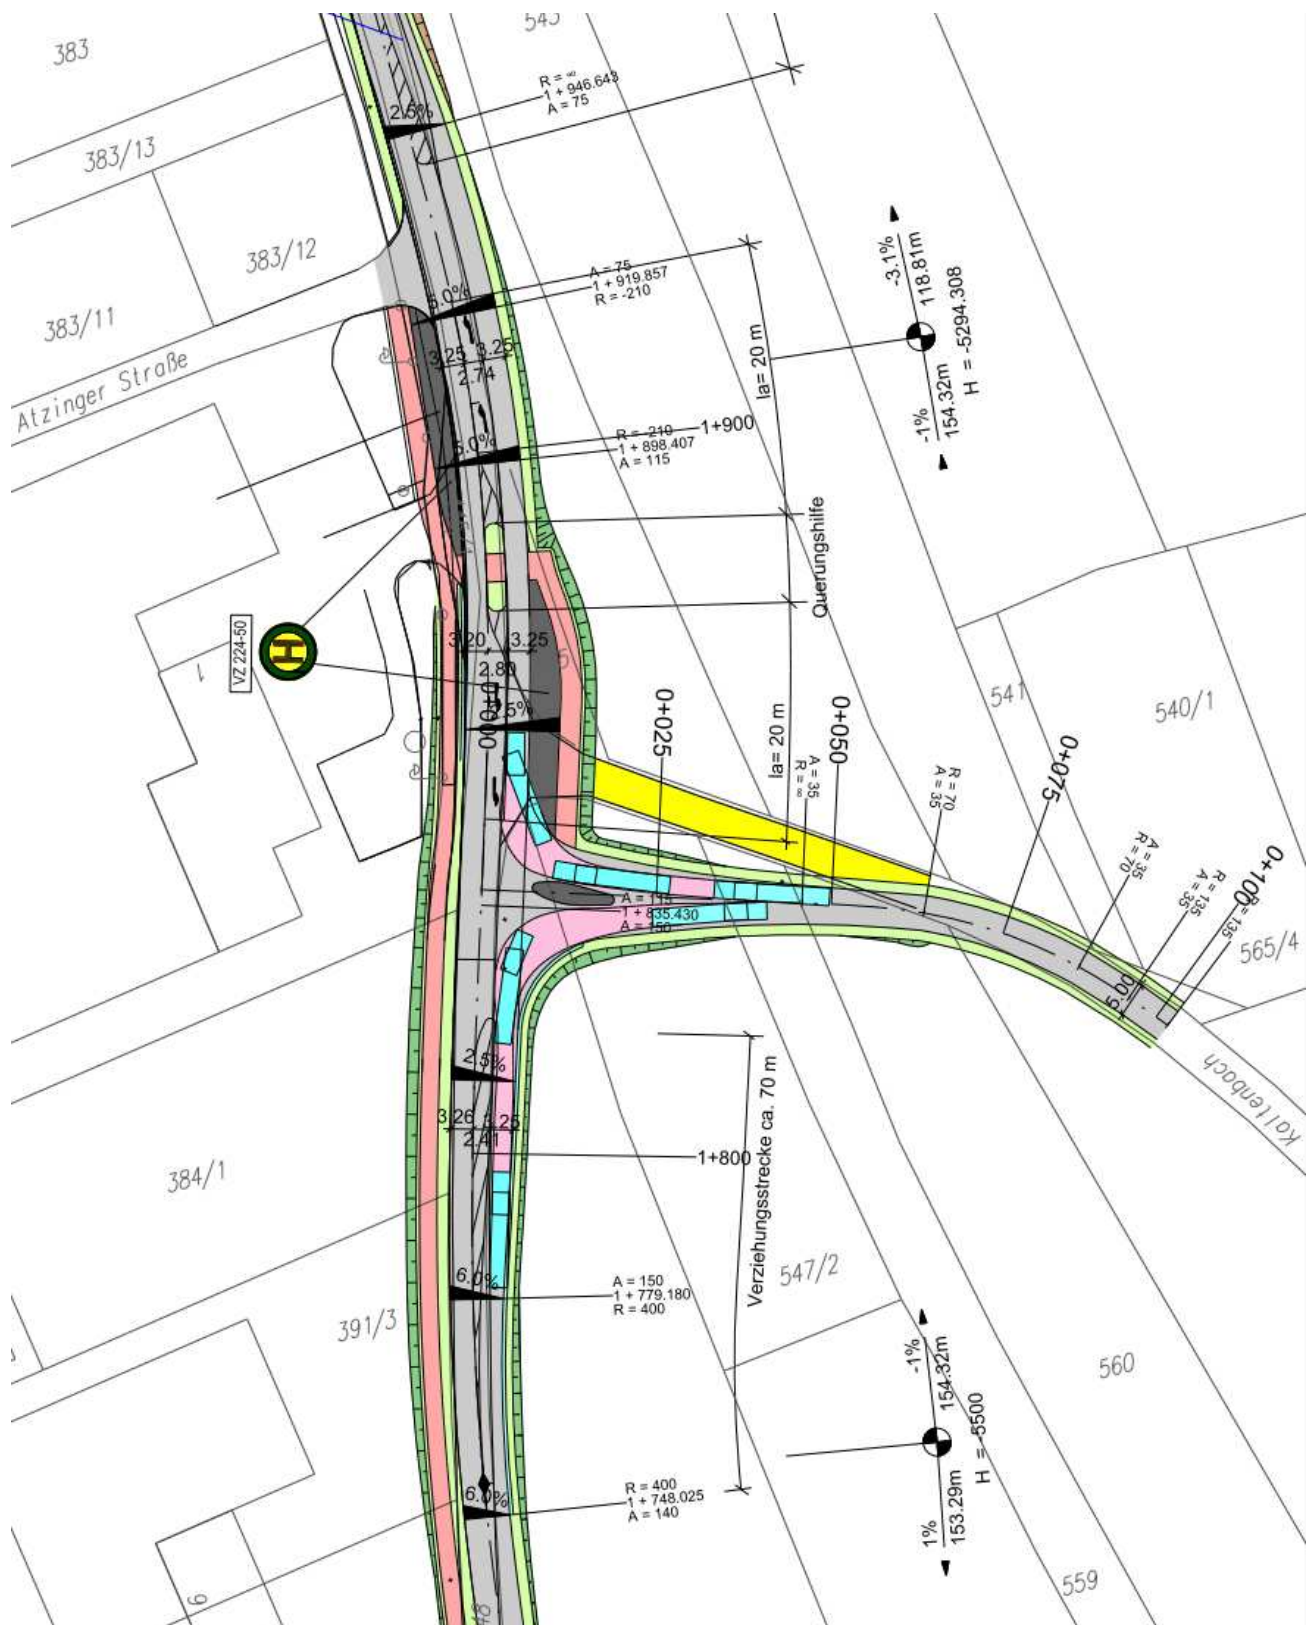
Lageplanausschnitt GVS Kaltenbach/ Atzinger Straße
